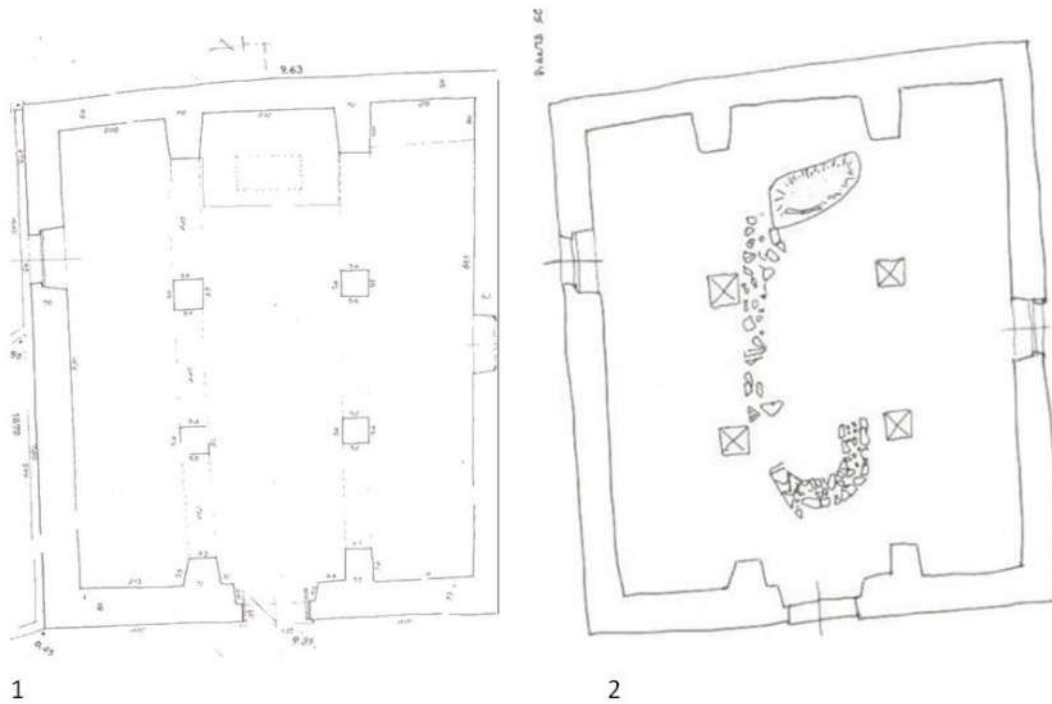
MURAVERA - Chiesa di Santa Lucia. Posizionamento in pianta delle strutture emerse con lo scavo. 1. Rilievo da progetto (di L. Murtas); 2. Rilievo da scavo (di P. Dessi).
